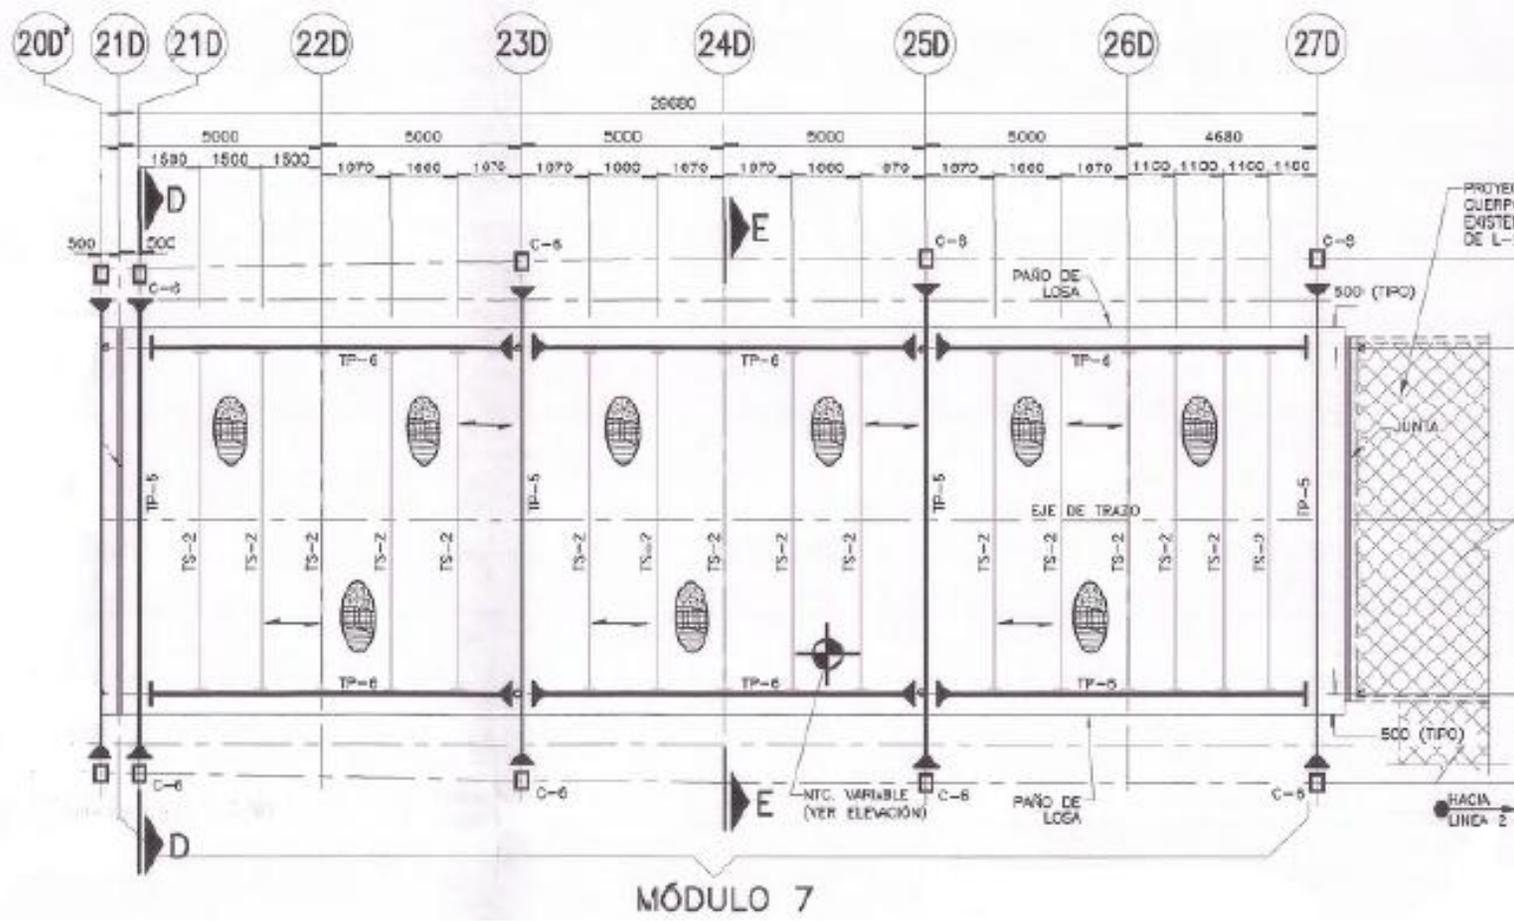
Planta de estructuración nivel azotea, módulo 7.
